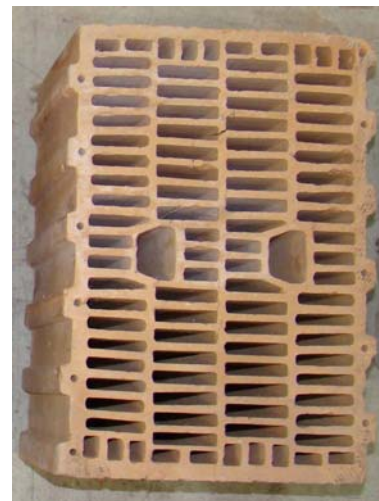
Planhochlochziegel HLzB 10-0,8 nach Zulassung Z-17.1-490
